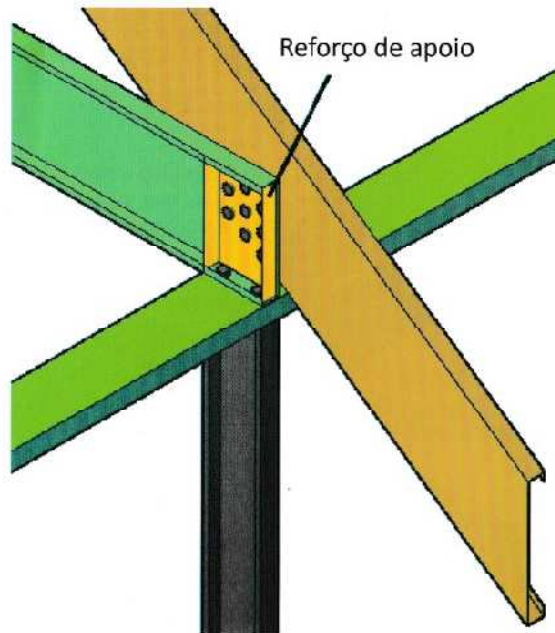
Por menor de ligação de viga no beirado com reforço do apoio
